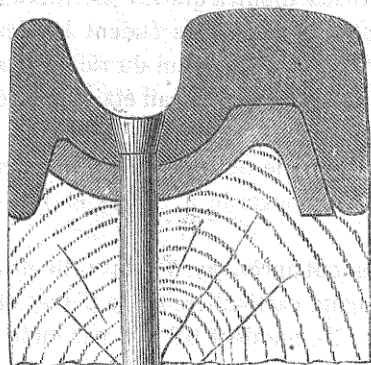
Tramways Nord. Section du rail, et attache. 23 kil. par mètre courant. Echelle 1/2.
